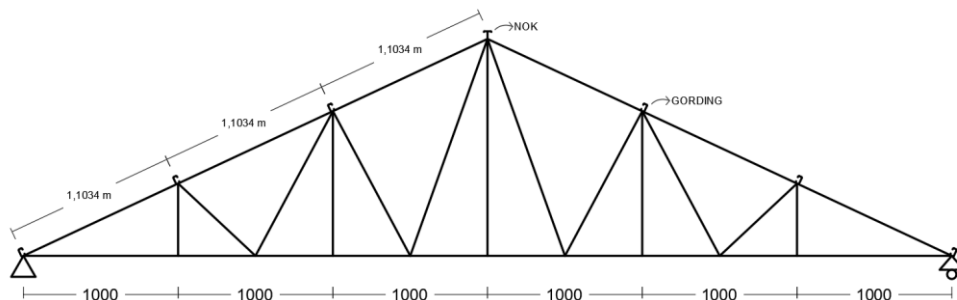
Denah Rangka Atap Bangunan A Satu Lantai
